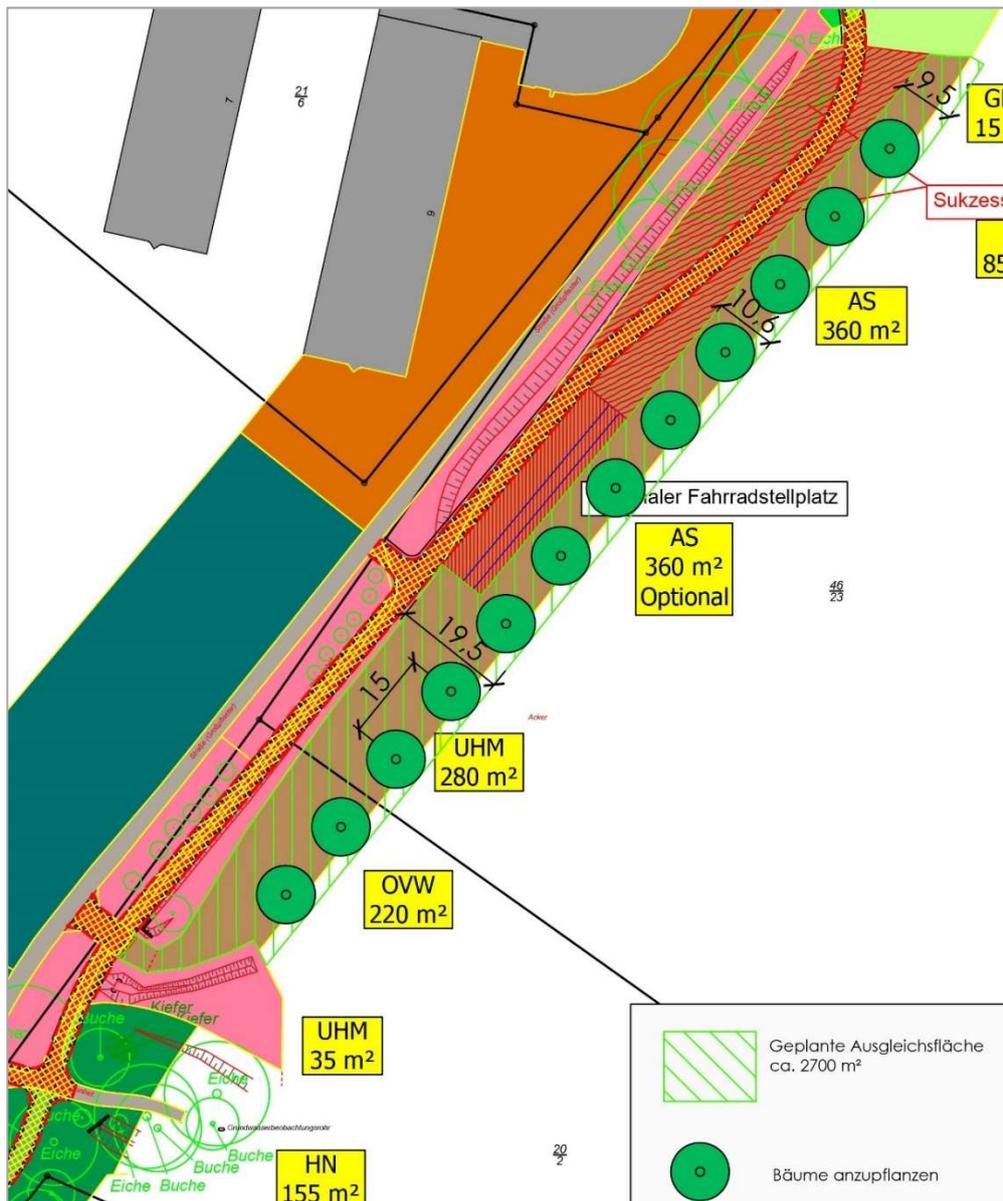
externe Ausgleichsfläche mit Anpflanzung Baumreihe auf Basis Entwurf LBP Radweg Brockwinkler Weg (Gemeinde Reppenstedt)
